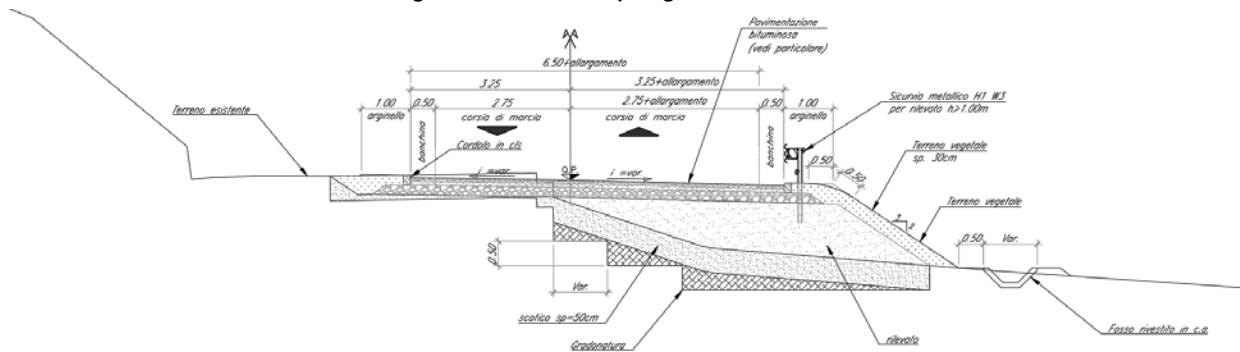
Sezione tipologica in rilevato con ammassamento NV03
